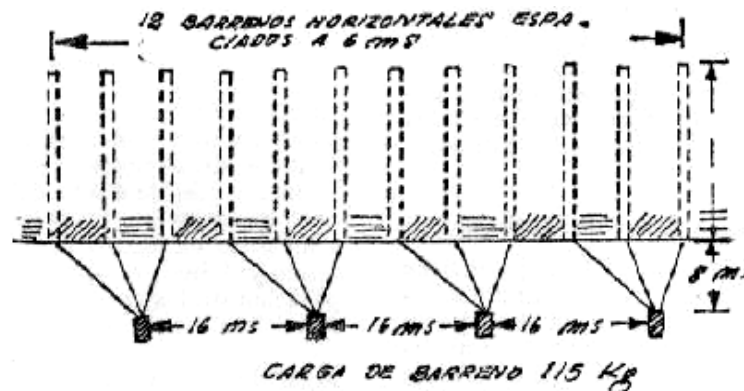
Plano para la distribución de explosivos en la zona de trabajo con barrenos horizontales
